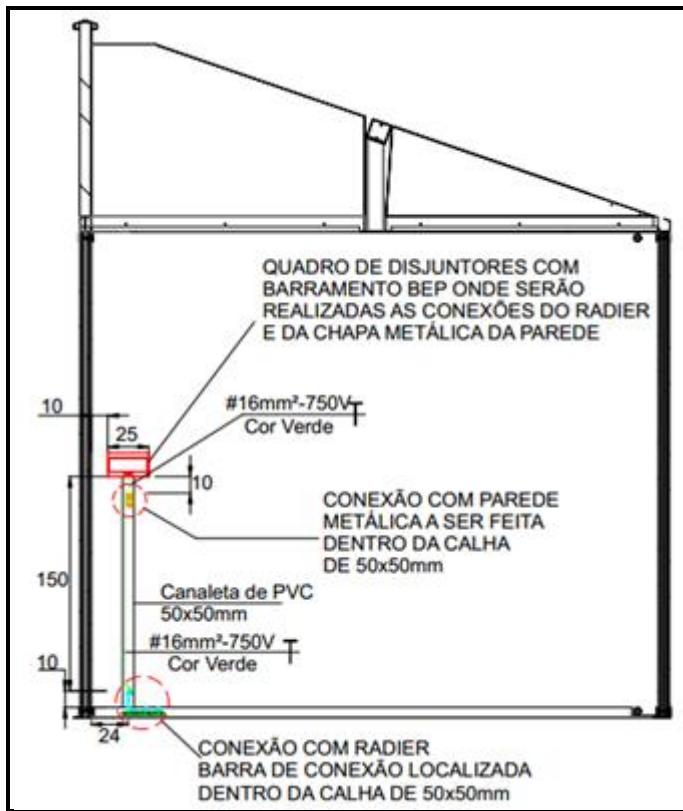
Conexão Barramento BEP x Radier x Chapa Metálica do Painel
